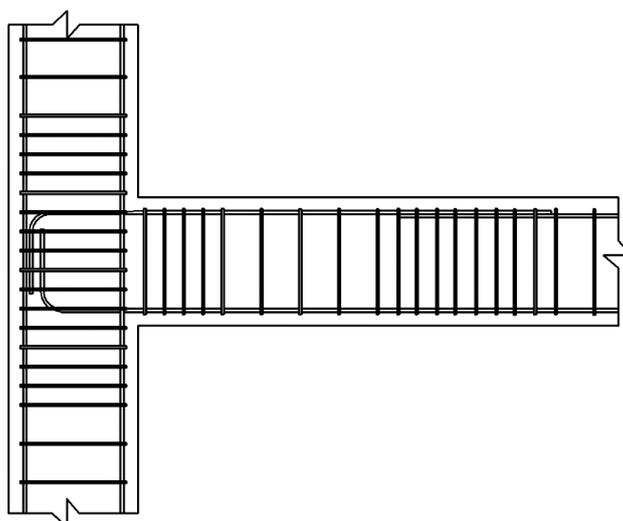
Ejemplo de colocación de refuerzo en los nudos de unión viga columna y en traslapos.
